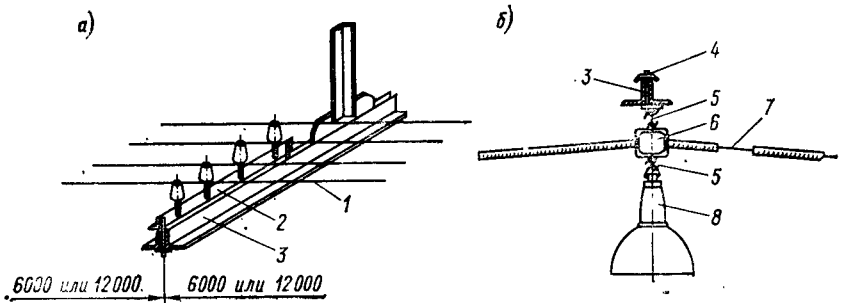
Проводка поперек ферм проводами на изоляторах (а) и тросовым проводом (б)
